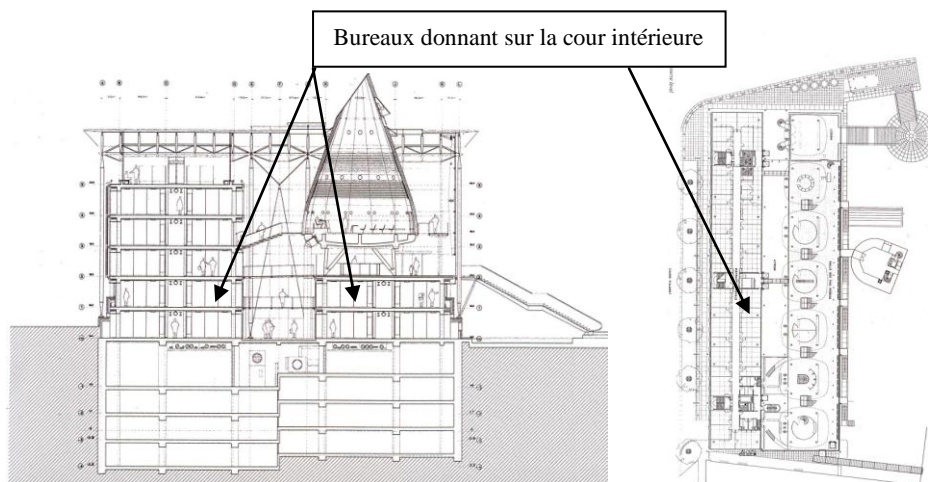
Plan et coupe sur les bureaux du palais de justice de Bordeaux
